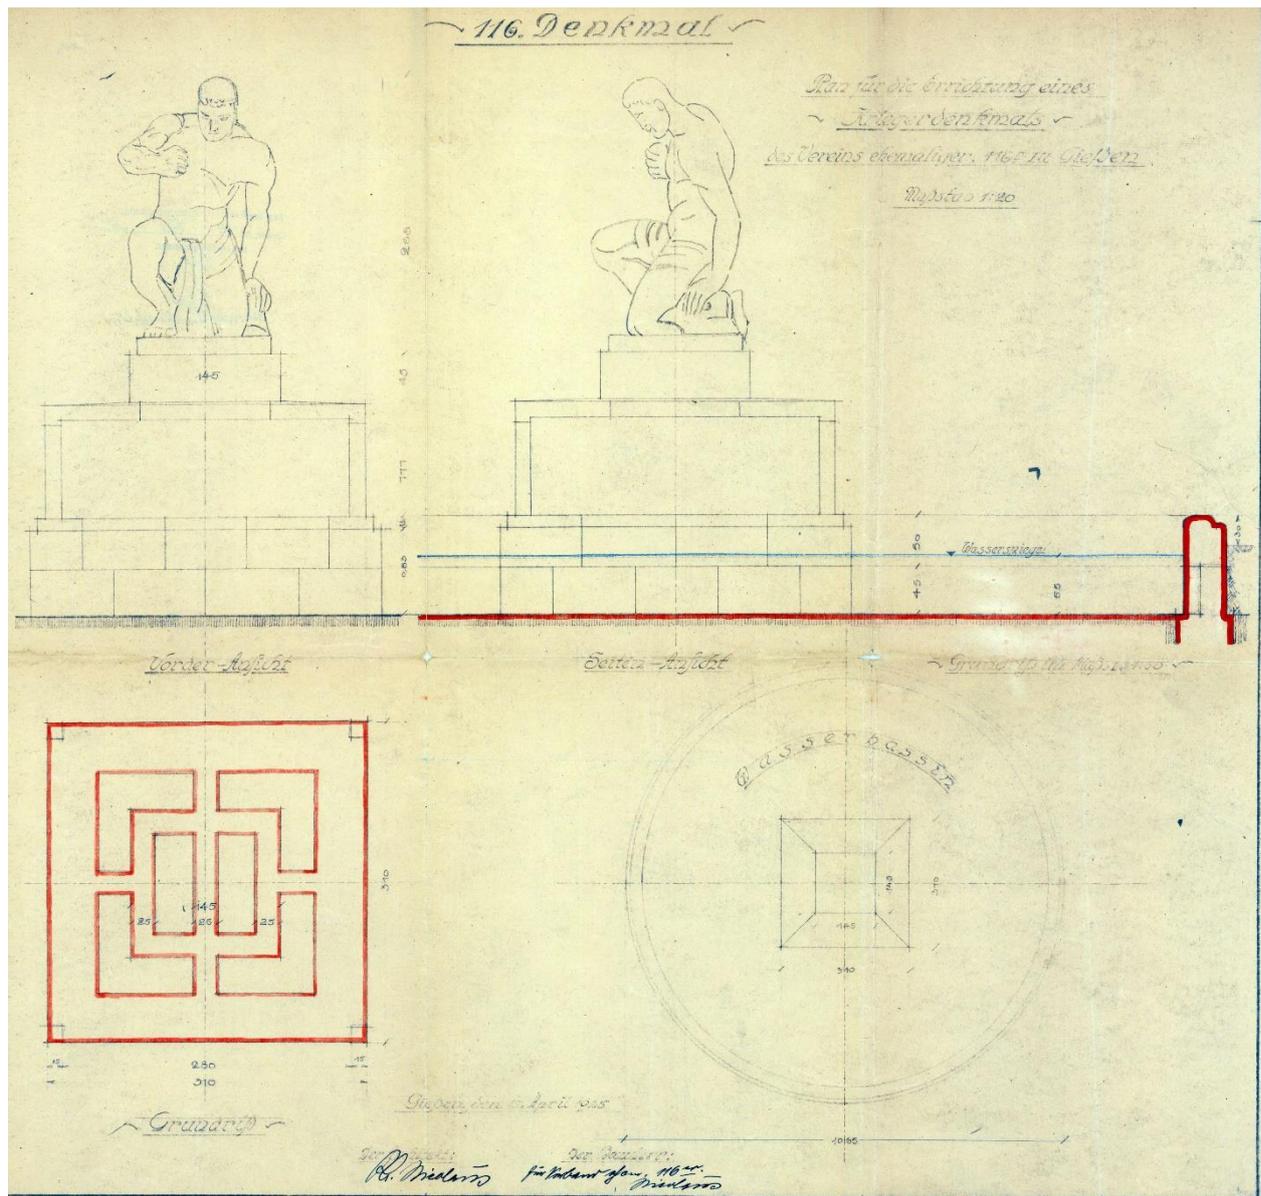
Plan für die Errichtung eines Kriegerdenkmals vom 15. April 1925 (Foto: Stadt Gießen).
